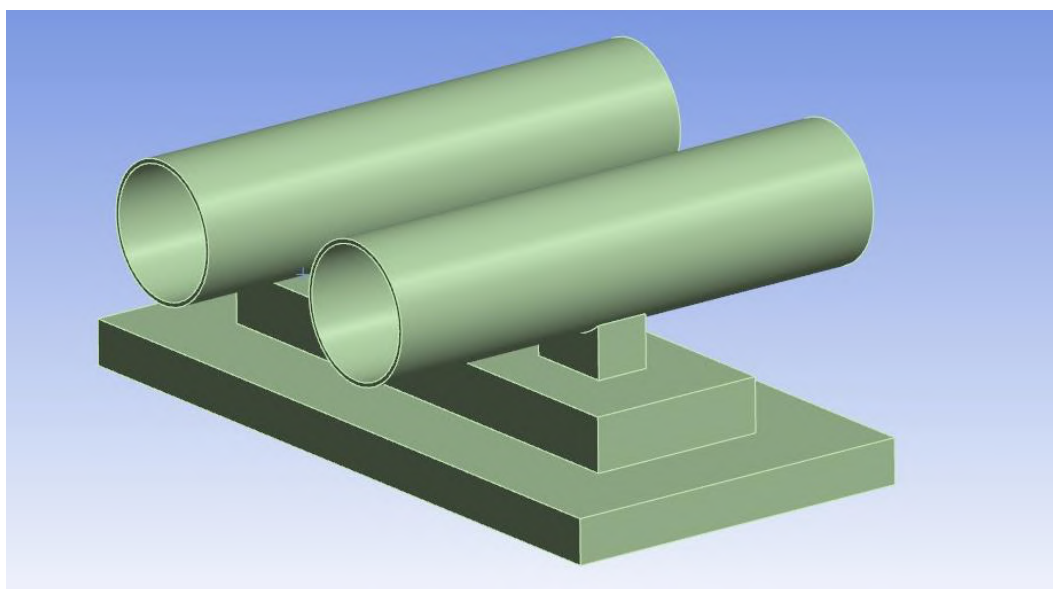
3D-геометрия трубопроводов тепловой сети при надземной прокладке на низких опорах
